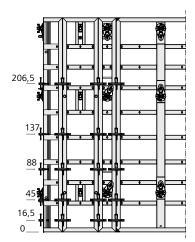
Hauteur de bétonnage jusqu'à 290 cm
